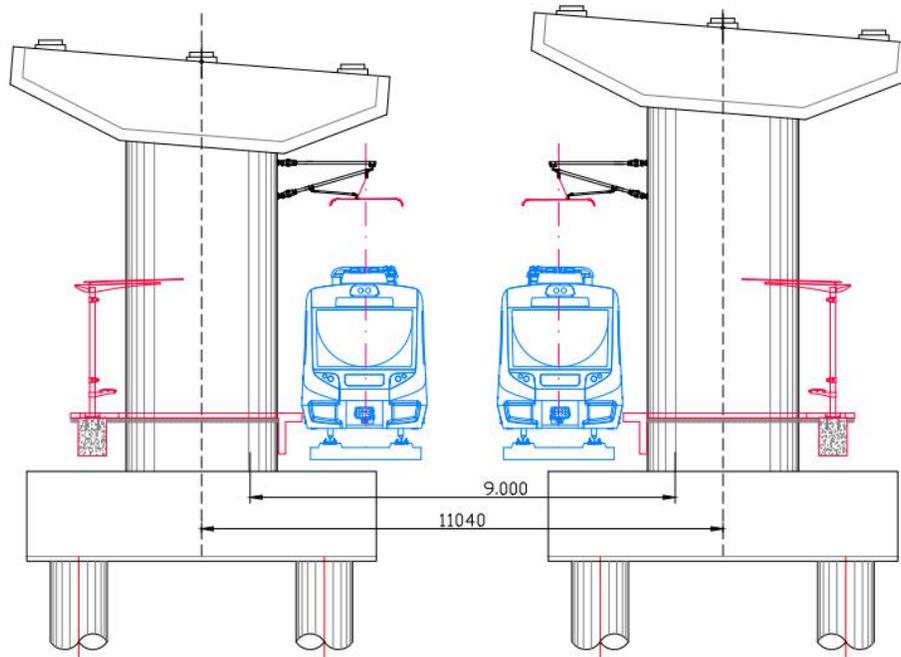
Propuesta 2 estación bajo viaducto. Pilas P-103I y P-103D, PK 30+700.
